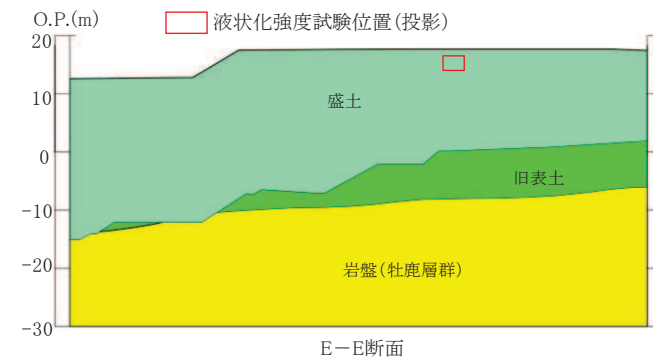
(1) 盛土の液状化強度試験に用いる試料採取位置断面図(1/3)
